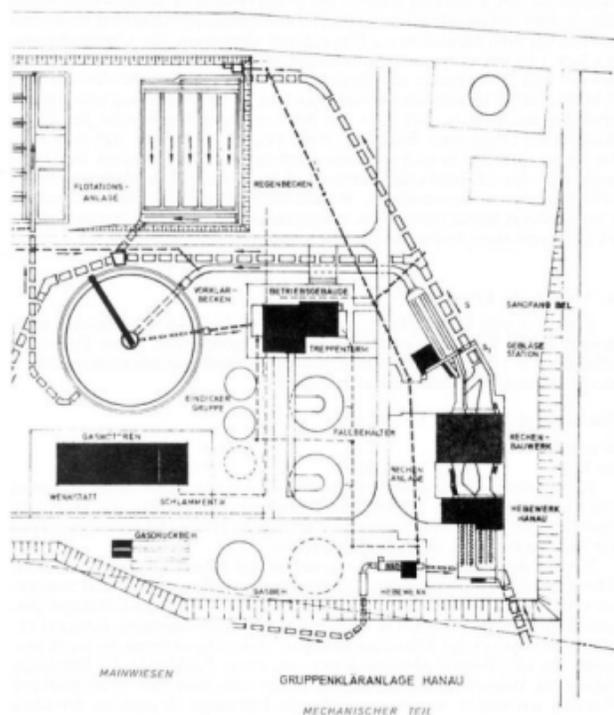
Lageplan der Gruppenkläranlage Hanau-Kesselstadt (mechanischer Teil)
